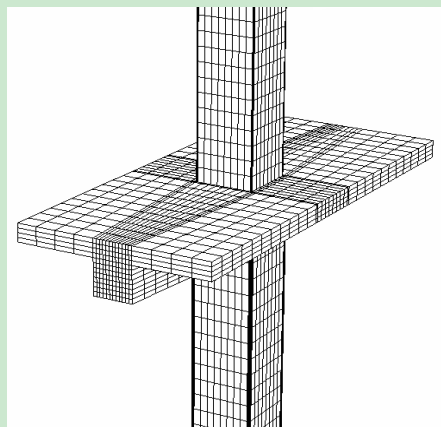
钢管混凝土柱-混凝土梁节点网格划分示意图
